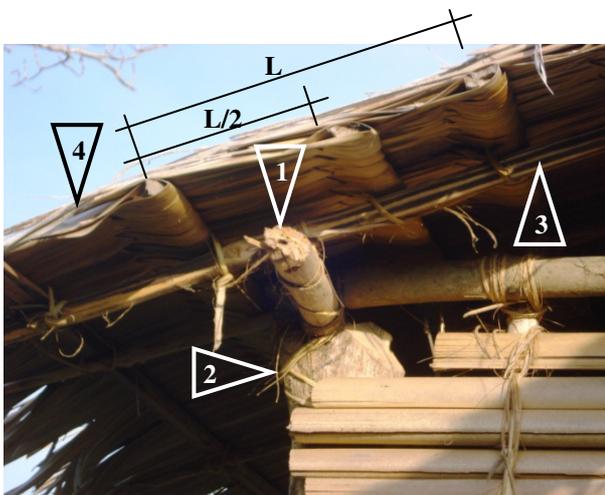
Detail (4): Mauerpfette und Dachdeckung (Quelle: privat, 15.12.2015)
